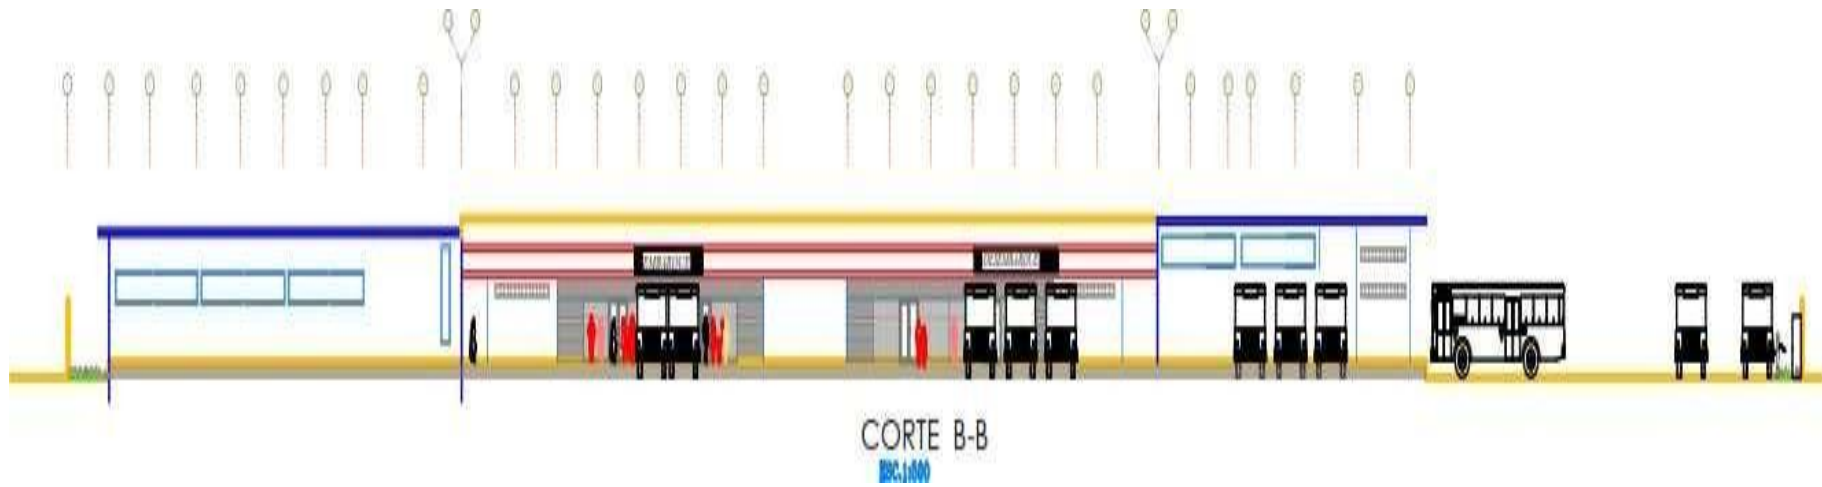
Planos del terminal de pasajeros de Tipo 3 para el cantón Chillanes (Vista posterior)
